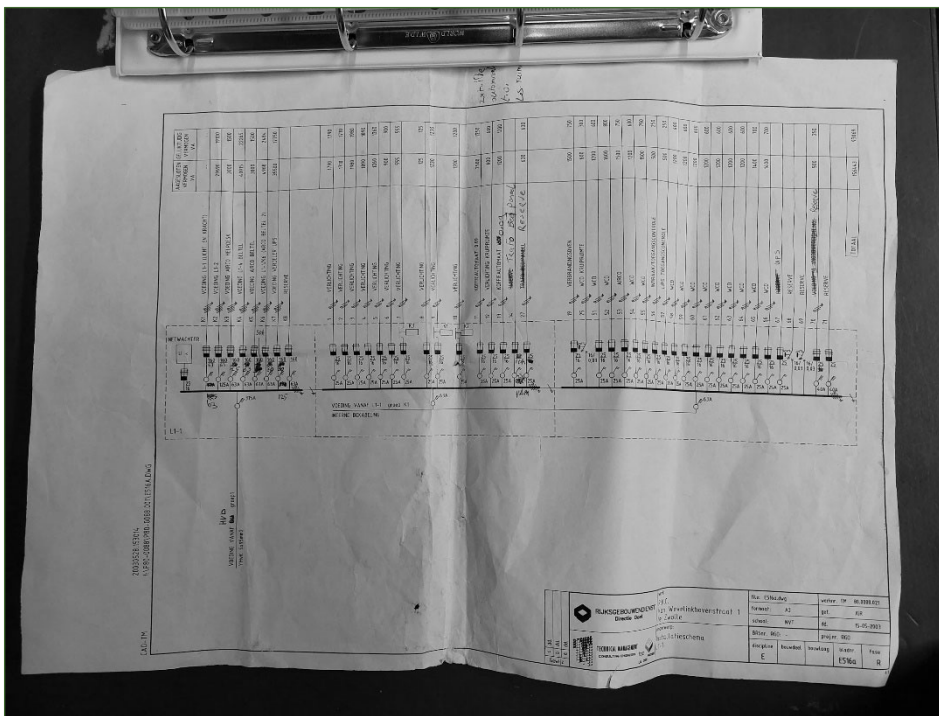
Installatieschema verdeelinrichting L1-1, overzicht.
